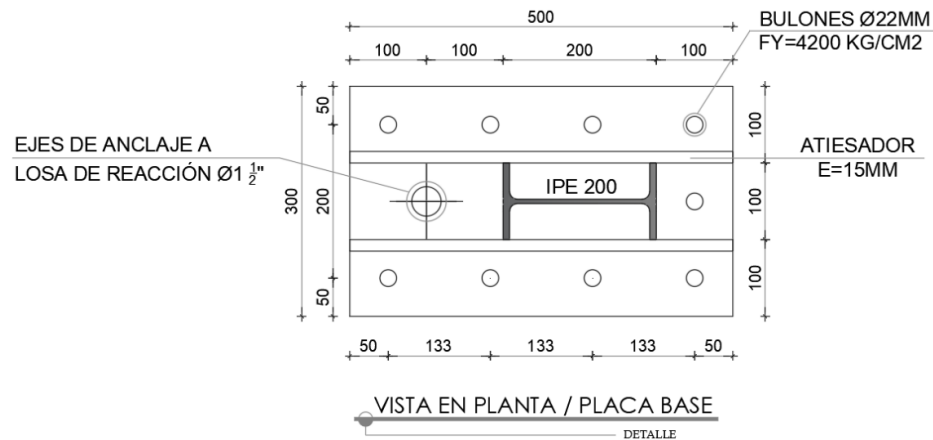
Vista en planta de placa base y ubicación de bulones de anclaje.
